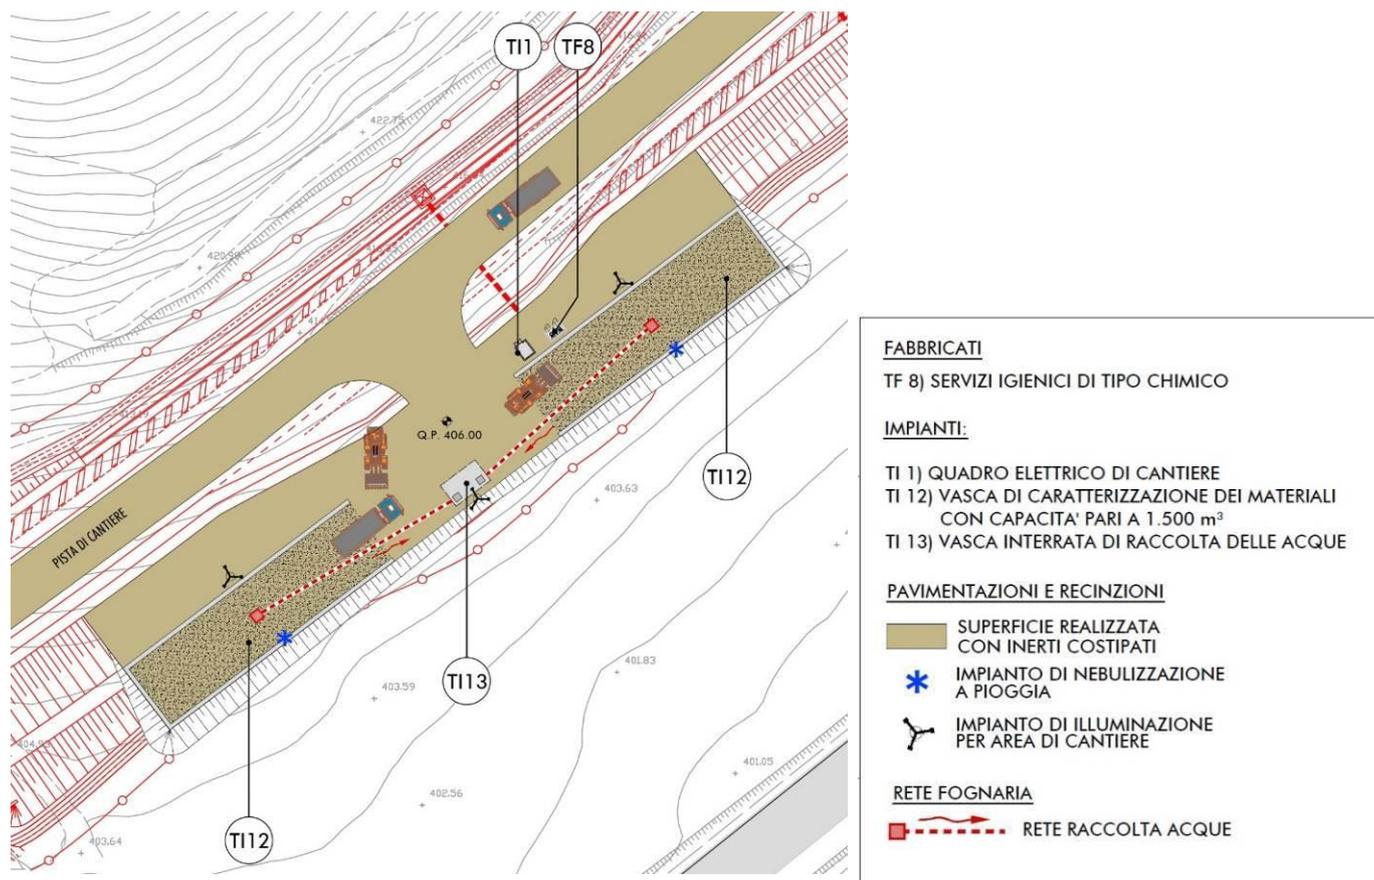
LAY-OUT FUNZIONALE DEL CANTIERE CO "C"
